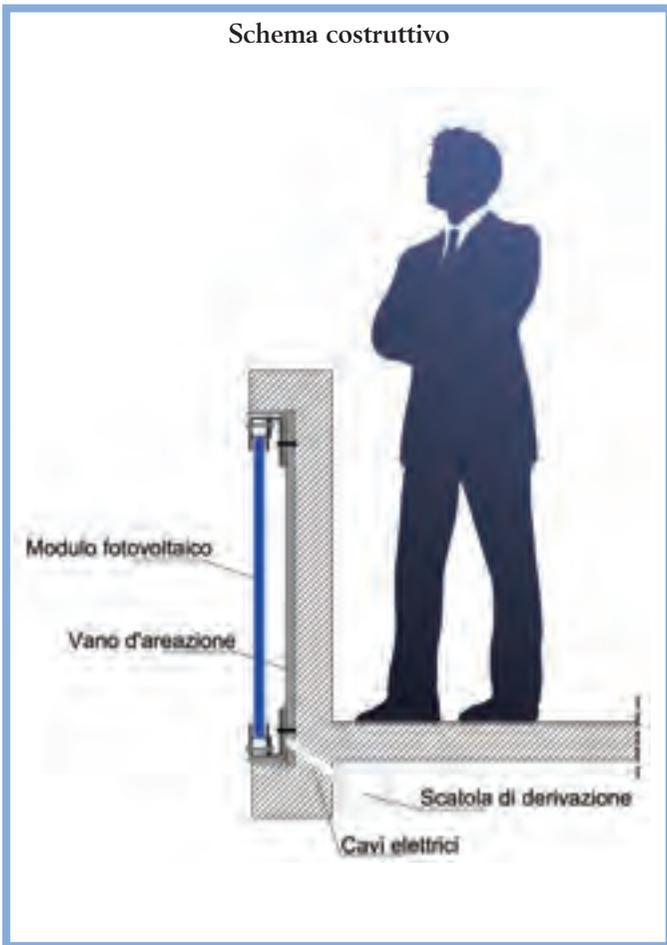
, 2 - Progetto studio Spagnolo - Rocchigiani
